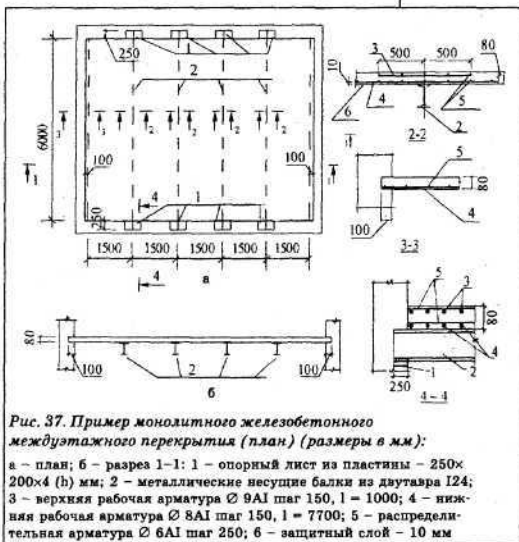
Пример монолитного железобетонного междуэтажного перекрытия (план) (размеры в мм):
